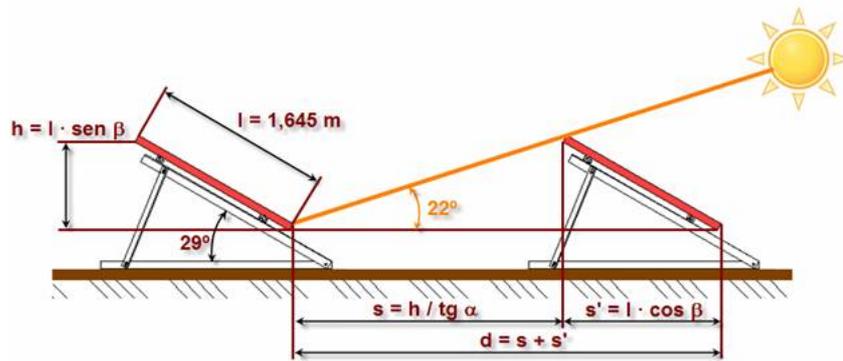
Cálculo de separación entre paneles en la planta fotovoltaica
